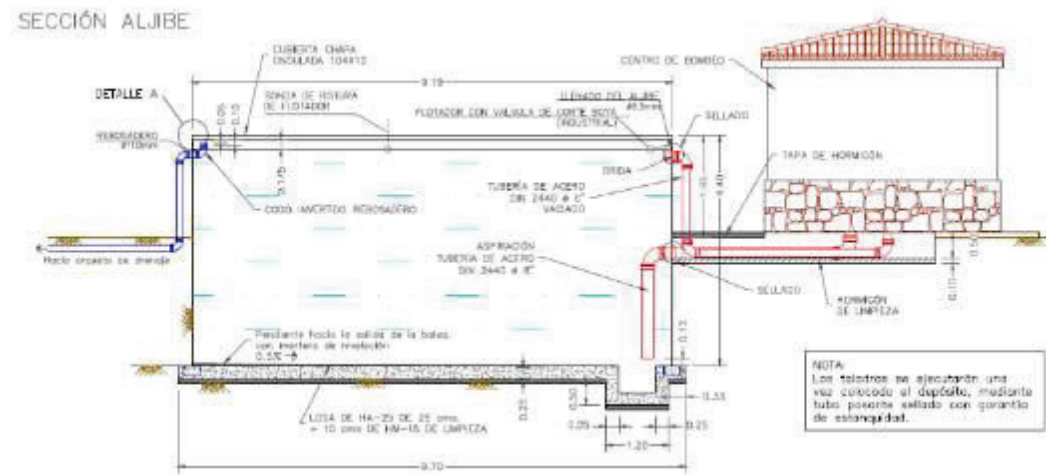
Sección del depósito de aguas – Extracto de los planos de Proyecto (Hoja N° 2)
